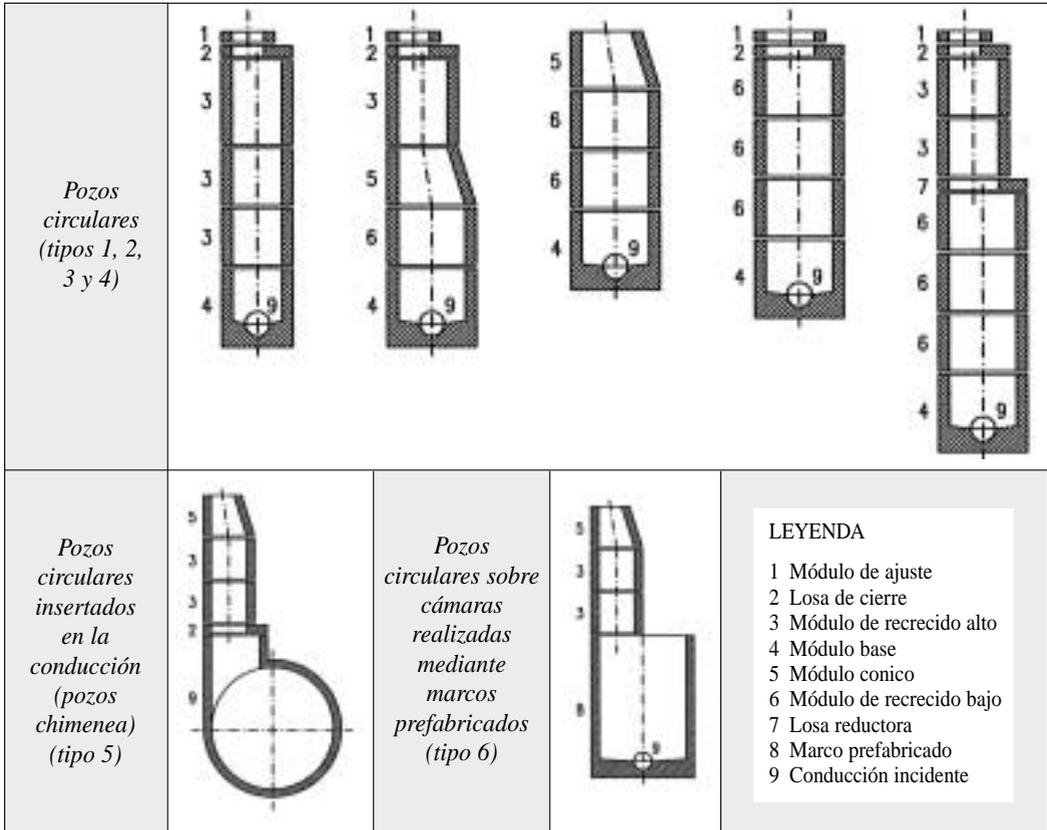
Tipología de pozos de registro prefabricados de hormigón armado.
